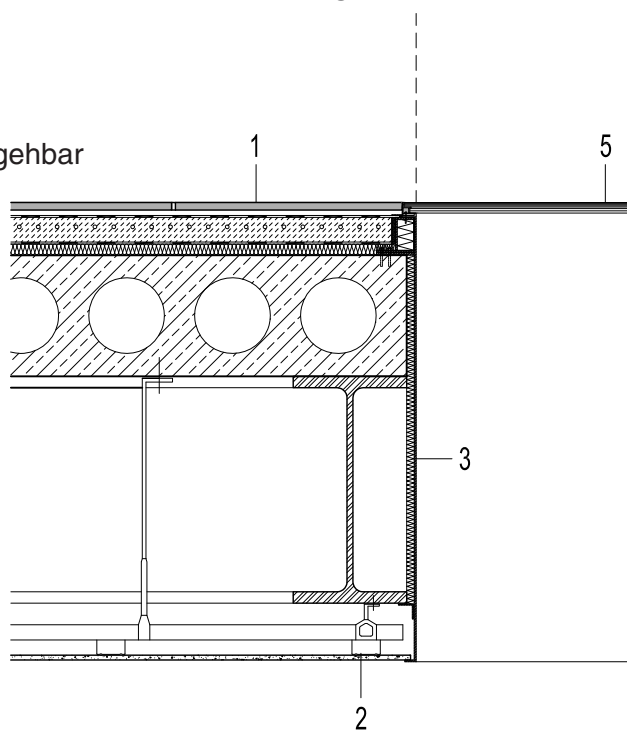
Detail nicht durchlaufender Lichtschacht, begehbar
